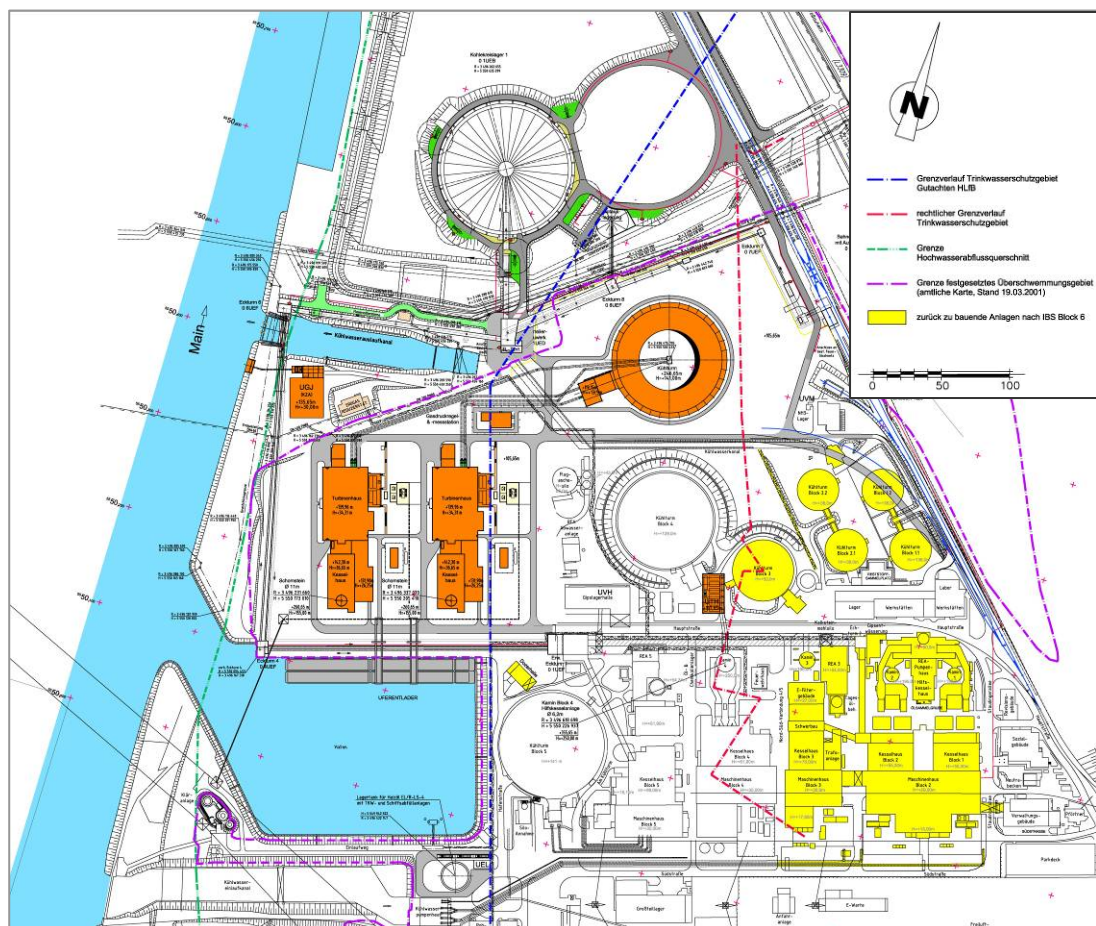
Lageplan Alternative GuD-Kraftwerk
